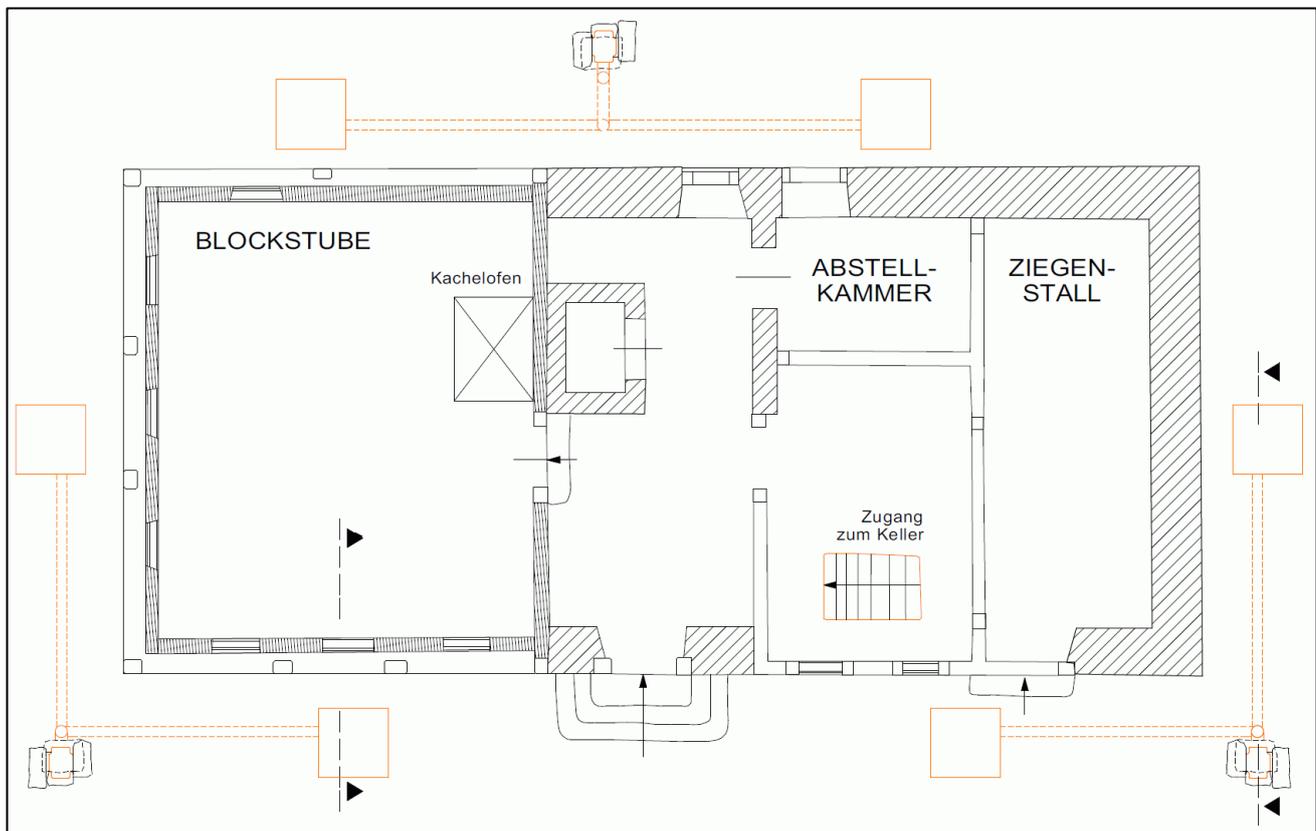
Anordnung Radonbrunnen, Grundriss
